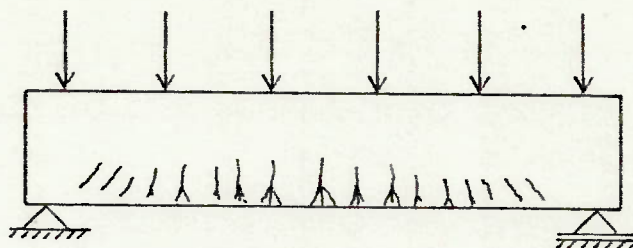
Ramificação das fissuras devida à presença da armadura de tração
